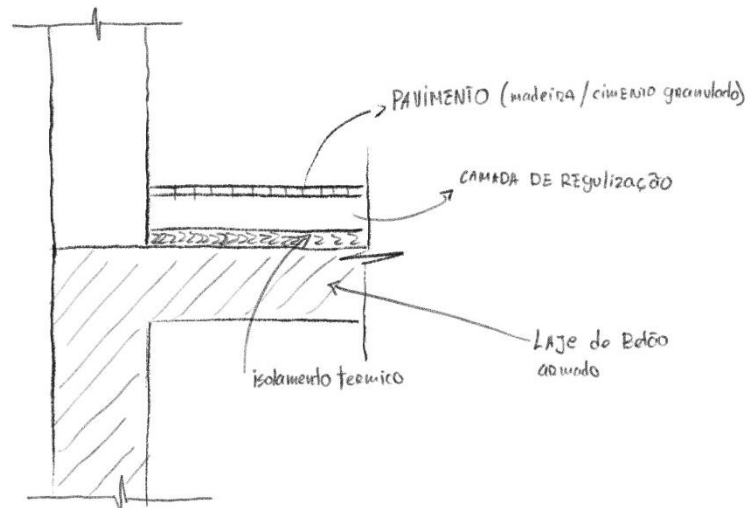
Pormenor construtivo do pavimento entre piso do rés do chão e primeiro pavimento
